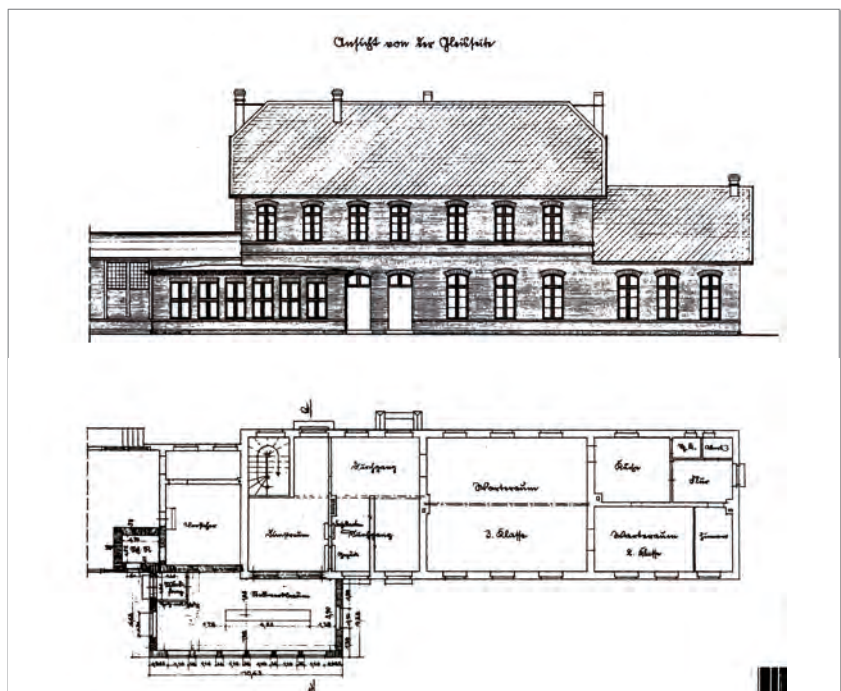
Bahnhofgebäude Bad Dübener Heide – Ansicht Gleisseite u. Grundriss
